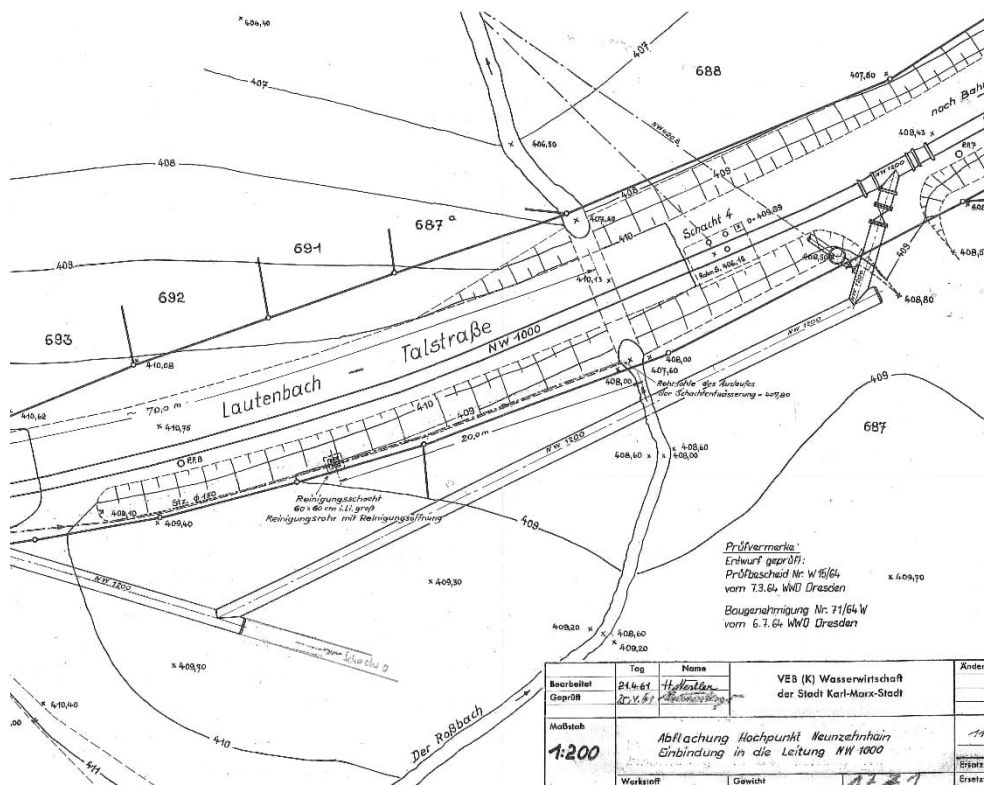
Lageplan Tiefpunktentleerung (Entwurf 1961)
